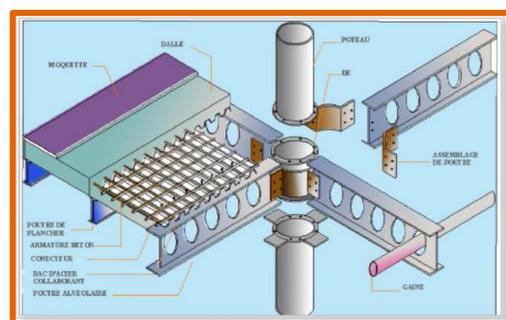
Détail de jonction Poteau, Poutre, plancher *Source : cour structure S9
